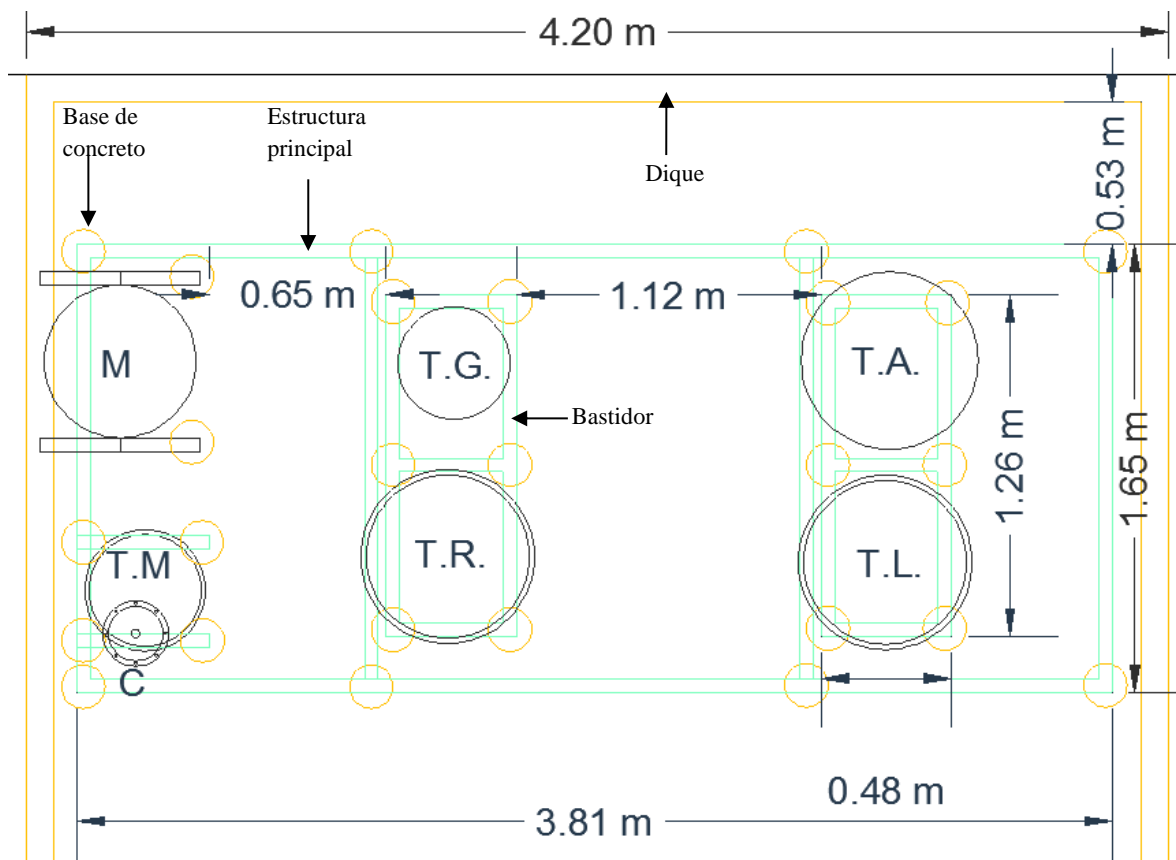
Esquema de diseño de escalamiento y distribución de la planta (Vista Planta)
